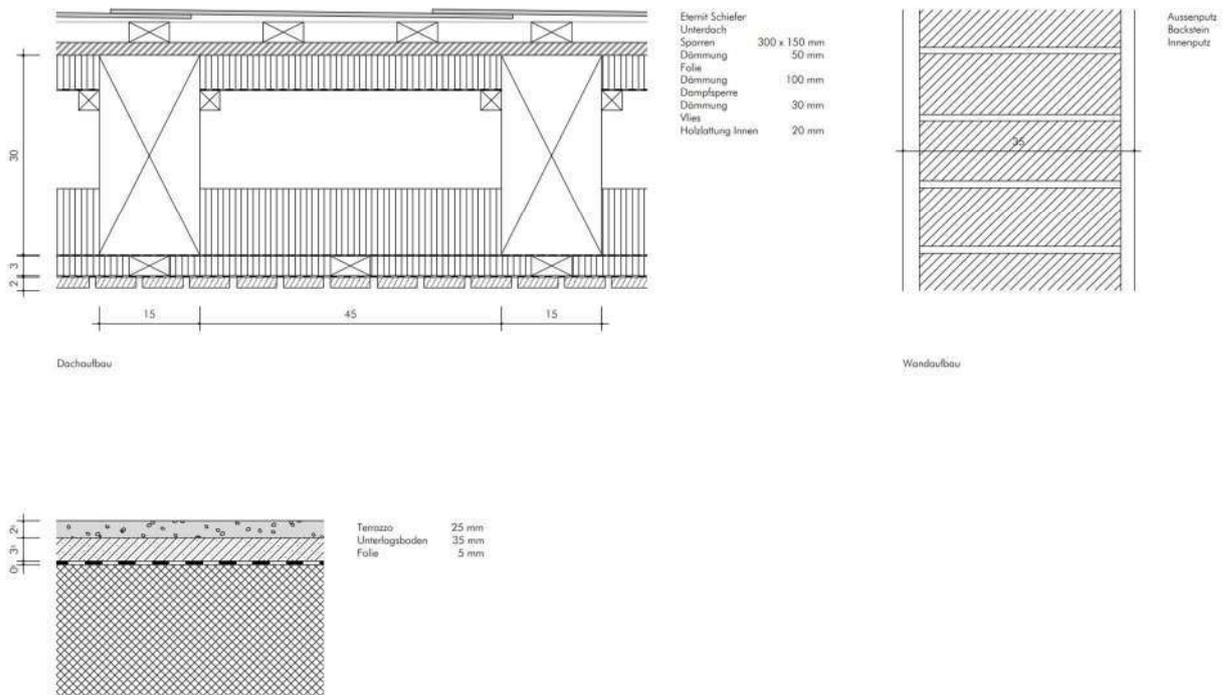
Bestand: Dachebene, Mauerwerk, Deckenaufbau
